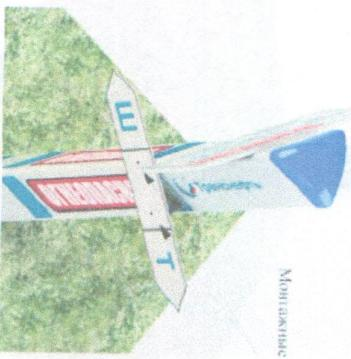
Установка дополнительного знака «Угол поворота».
